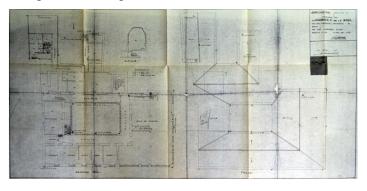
Deterioro de planos - Fuente: Museo Natural de Arte.
